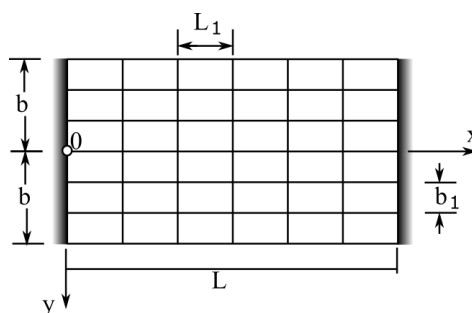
Distribuição das vigas longitudinais e transversais no eixo cartesiano. (Massonnet, 1960).
